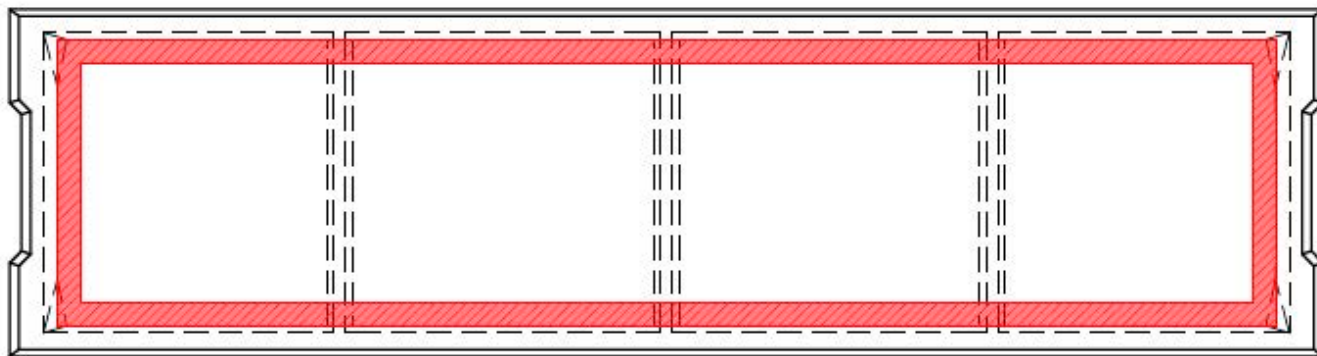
Схема армирования и зоны крепления в плиту. Вид сверху
